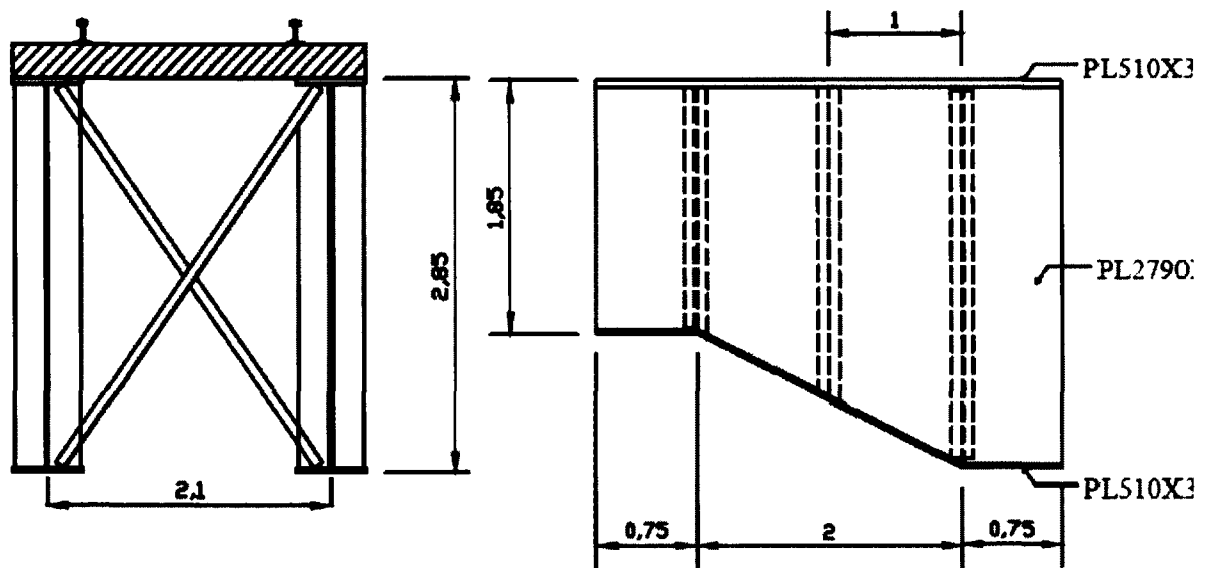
Pont bi-poutres - Section transversale et élévation - Section C
